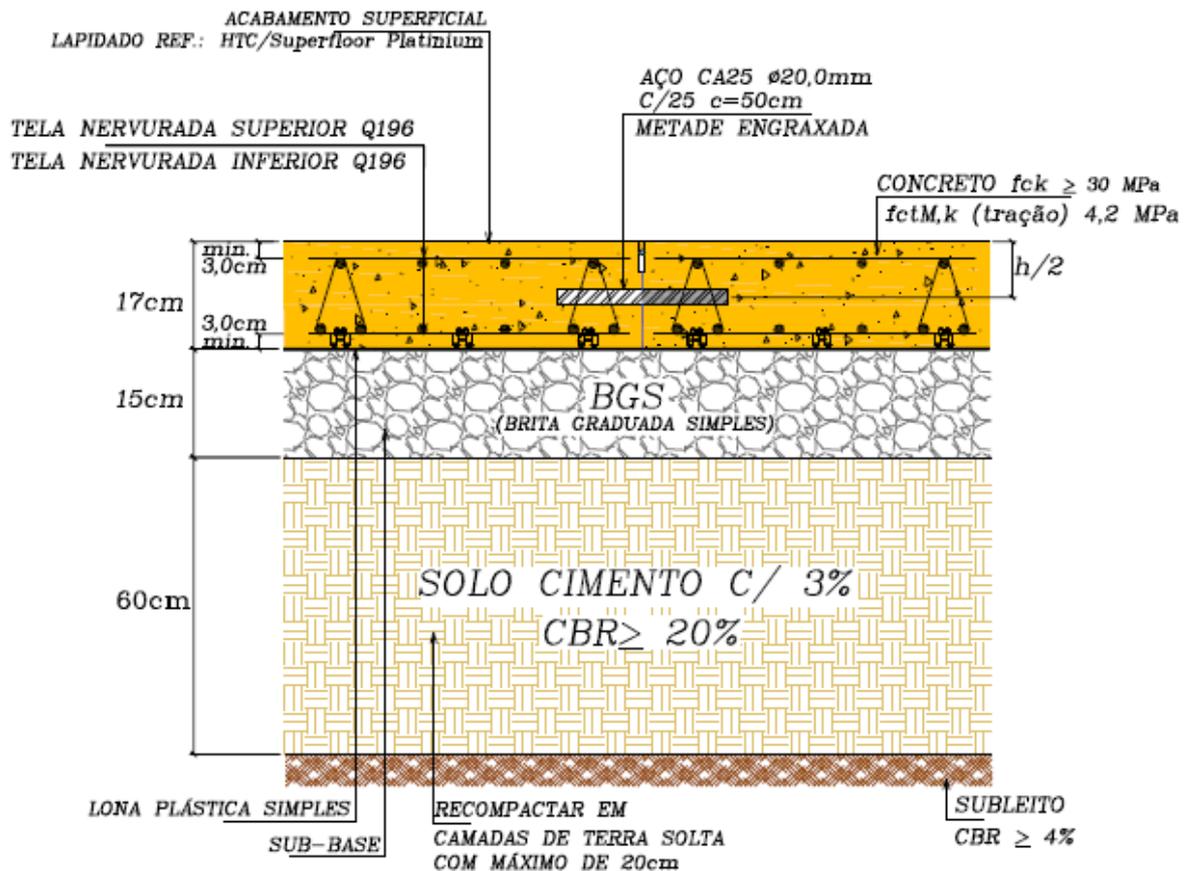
Detalhamento do piso de concreto - área interna.
